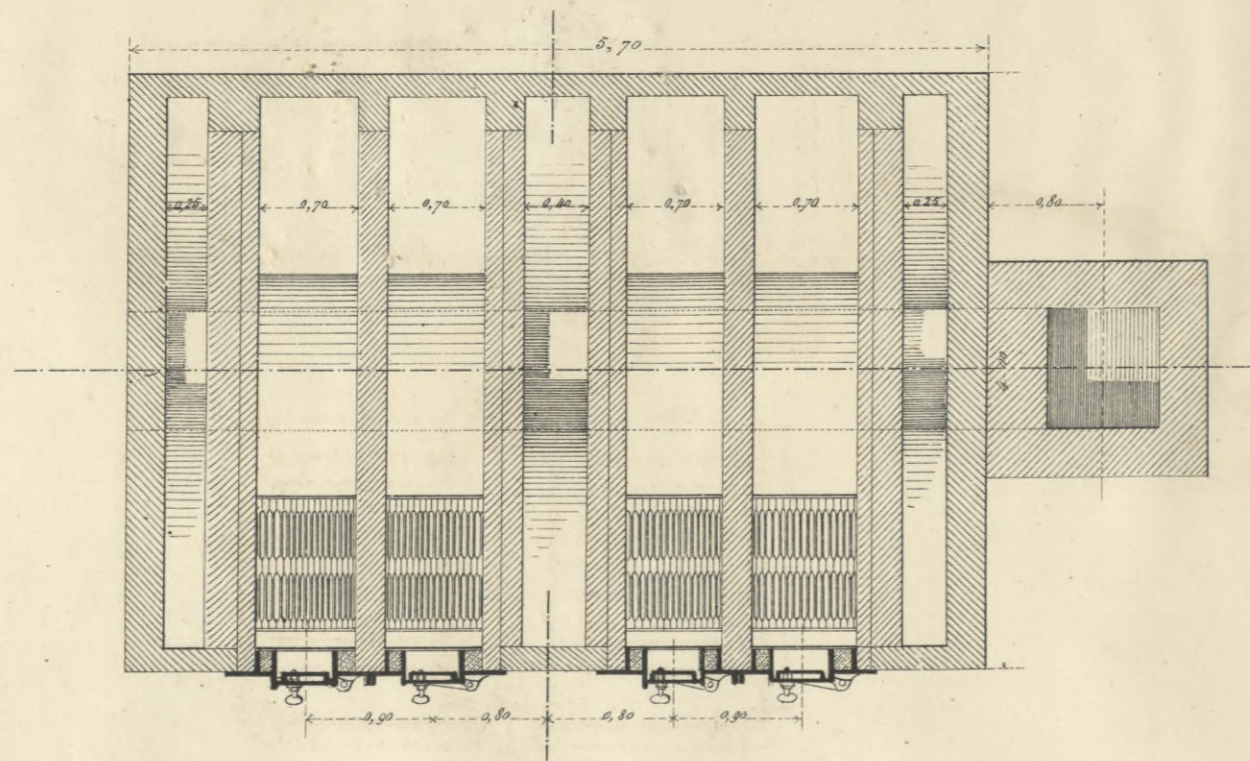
Coupe horizontale à 0,02 pour 1⁰⁰⁰. — Plan.
